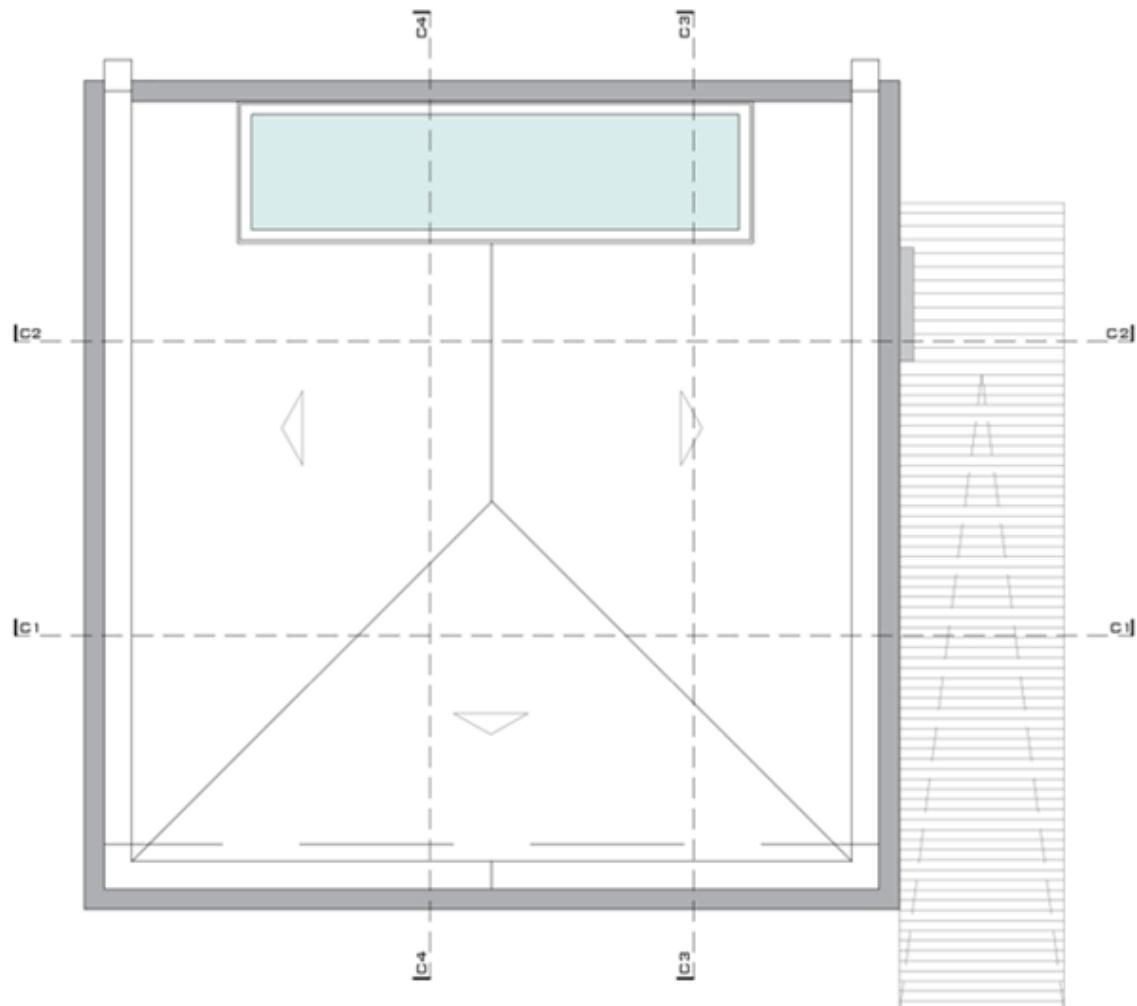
Planta Cobertura - Integração da Solução Construtiva CircularBuild
